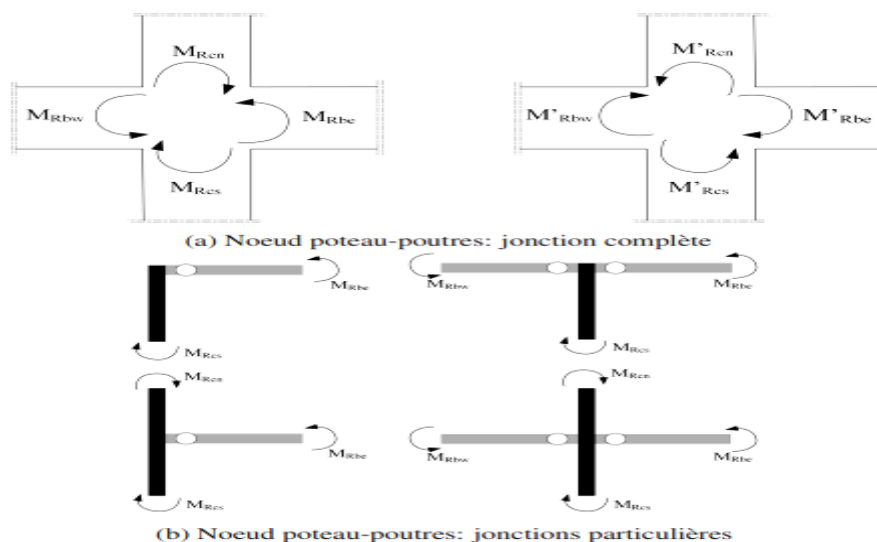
Dimensionnement d'un nœud poutre-poteau [5]
